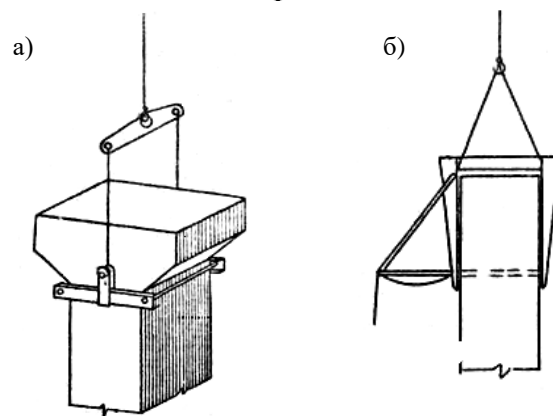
Схема строповки колонн: а) колонна с консолями; б) колонна безкансольная.
